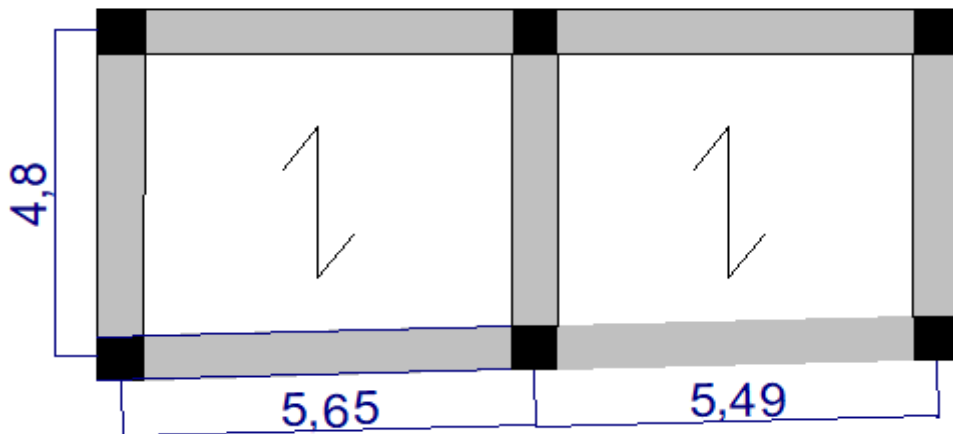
Dispositions des poutrelles du RDC au 7^{ème} étage
